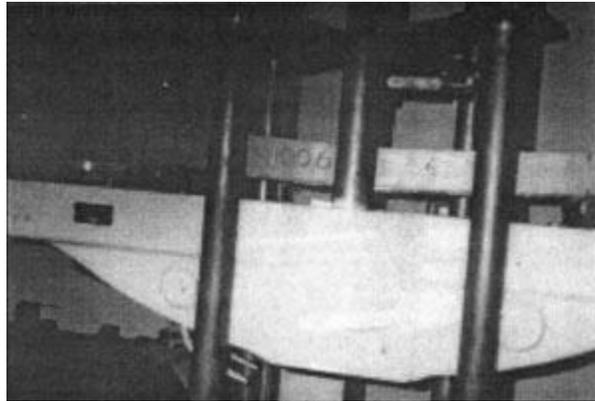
Probeta de madera reforzada sometida a flexión estática, en máquina universal
